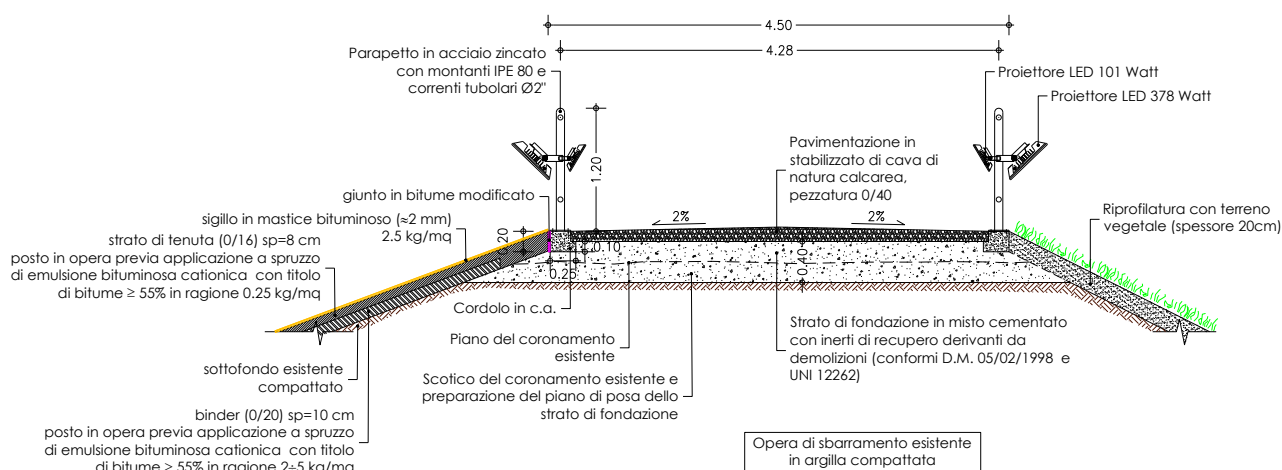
Opere ed interventi previsti sul coronamento della diga
